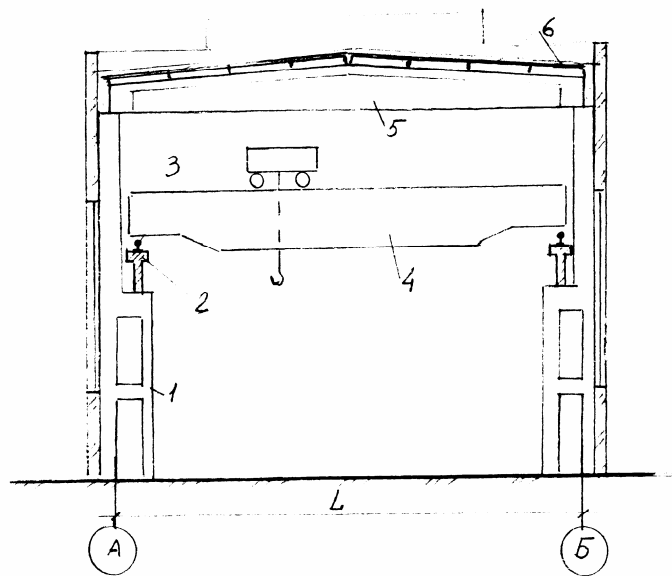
Поперечний переріз одноповерхової промислової будівлі:
